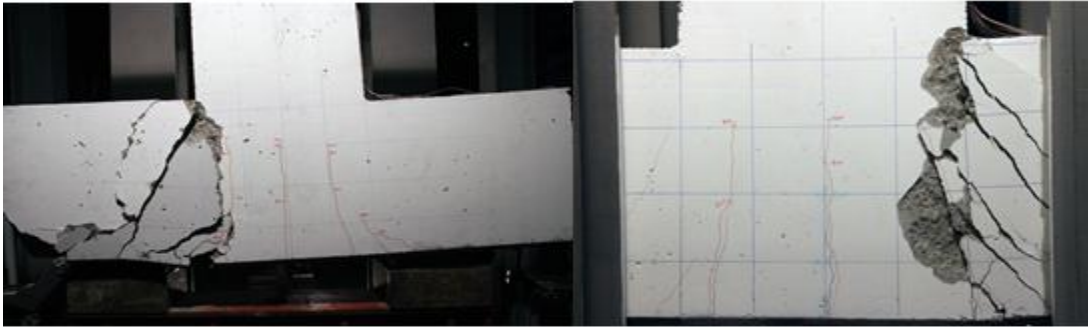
Foto de Roturas Encepados AB0_0, (NO Arm.Sec) derecha, Encepado AB1_1 (con Arm. Sec.) Izquierda
